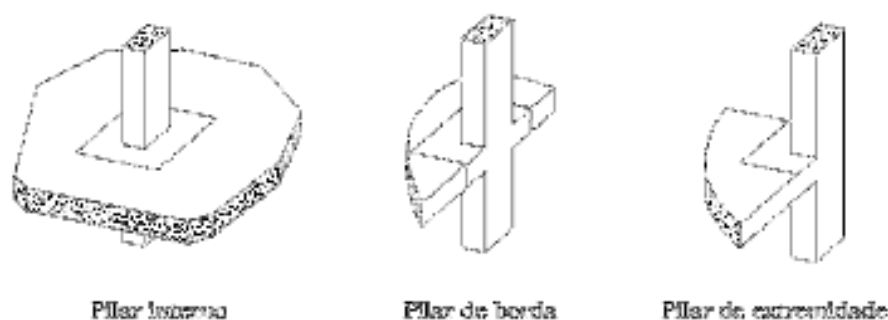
Tipos de ligação Laje-Pilar para o puncionamento – Fonte: Almeida (2002)
